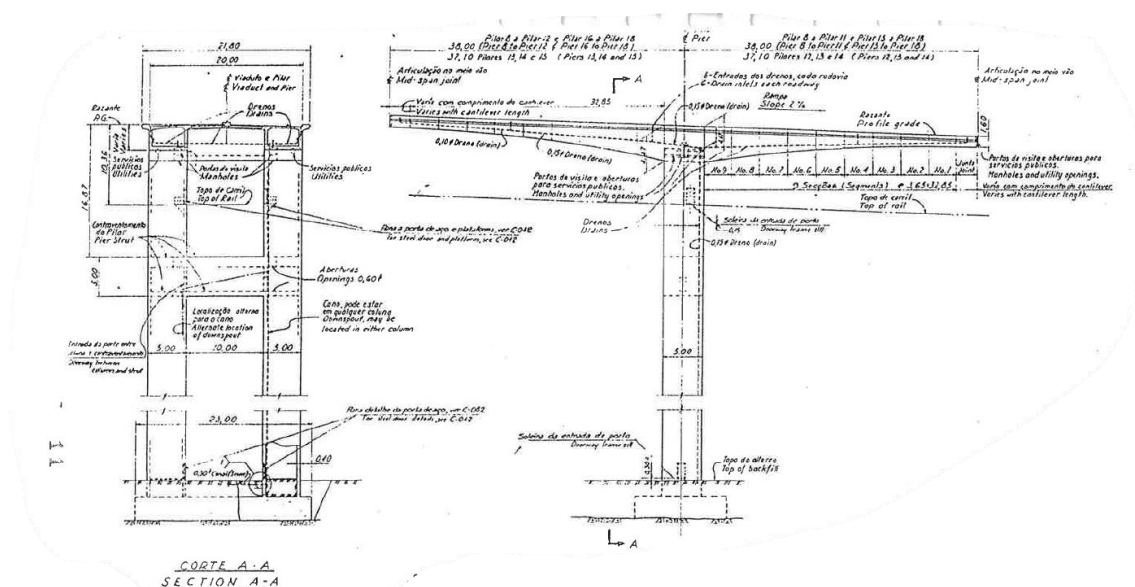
Pilar P18 (Peça desenhada nº C-011 As-Built 1962)
